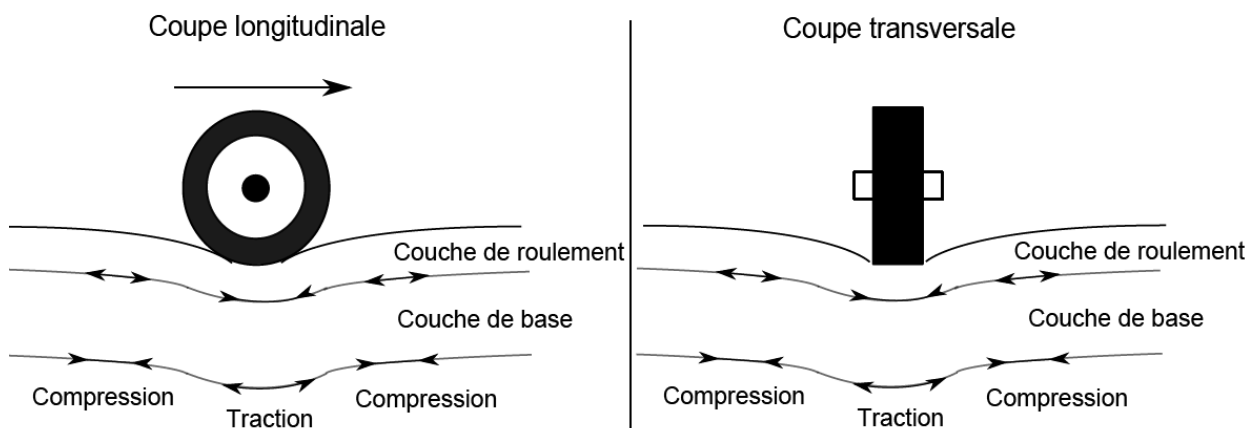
Sollicitation d'une chaussée par le passage d'une charge
